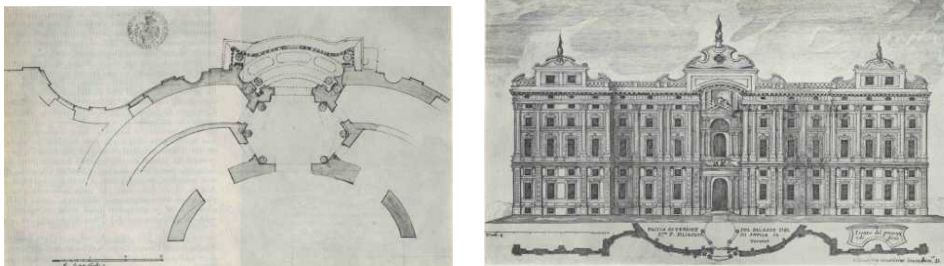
e Fig 9 - Guarino Guarini. Palazzo Carignano (1679-1684), Torino. Detalhe da Planta Baixa e da fachada. Fonte: <https://archive.org/stream/ArchitetturaCivile/opera#page/n3/mode/2up>
